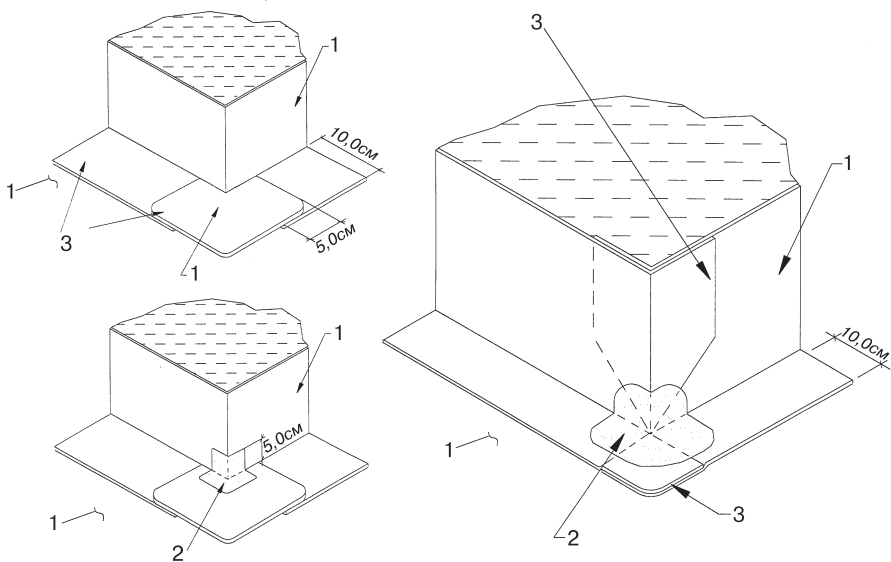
Устройство кровли на внешнем углу, например, вентиляционной шахты без применения заводского элемента
